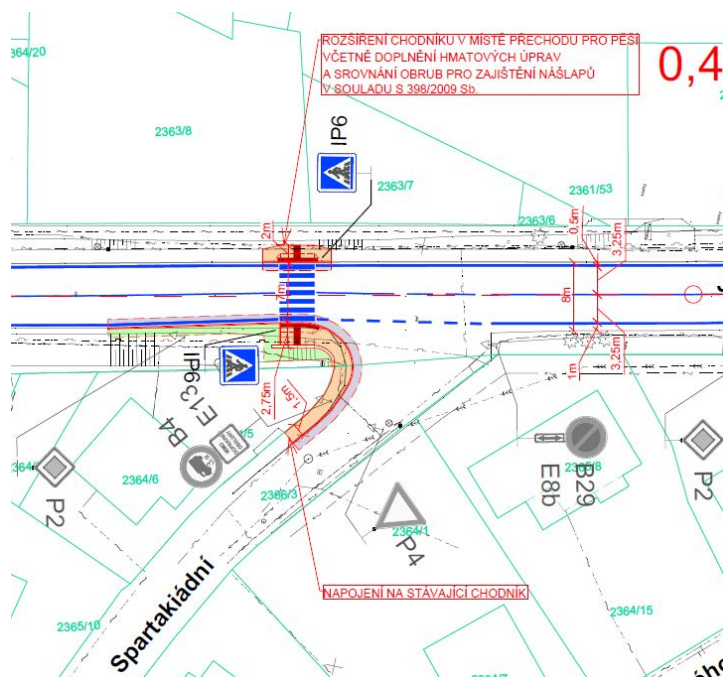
Rekonstruovaný přechod pro pěší včetně úpravy napojení ulice Za Nádražím
